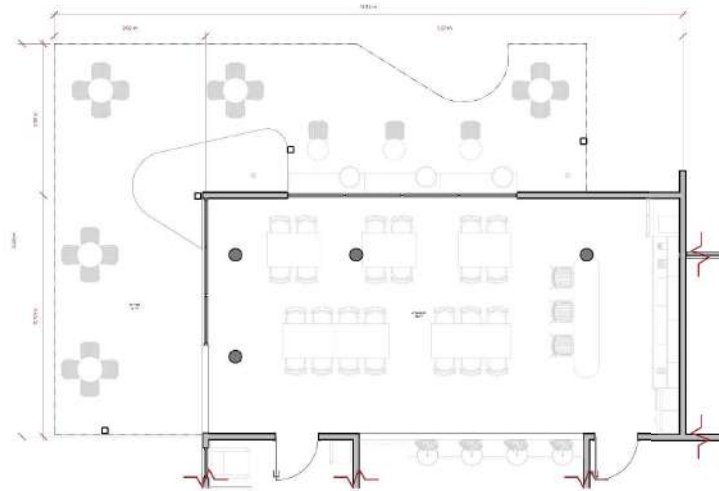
Detalle comedor y terraza de trabajadores. Fuente: Elaboración propia
